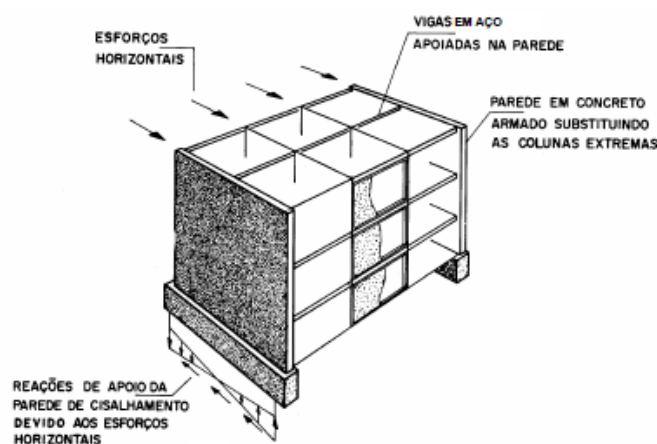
Parede de contraventamento ou cisalhamento em linha inteira
